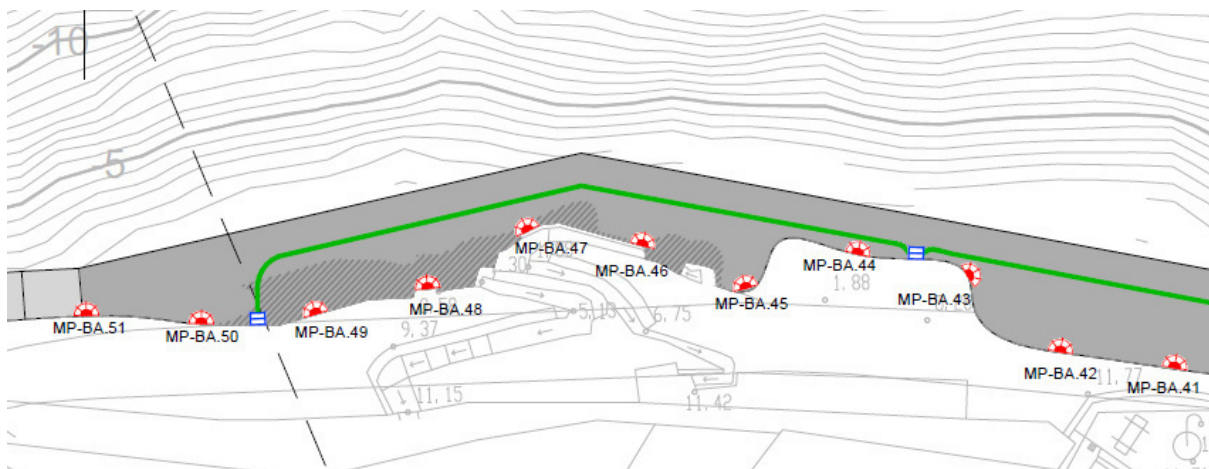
Propuesta de instalación eléctrica en planta en el tramo de muelle de gravedad.
